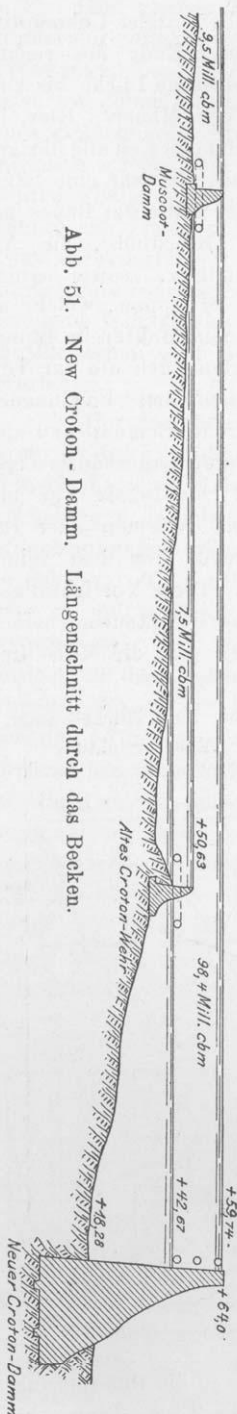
New Croton - Damm. Längenschnitt durch das Becken.
